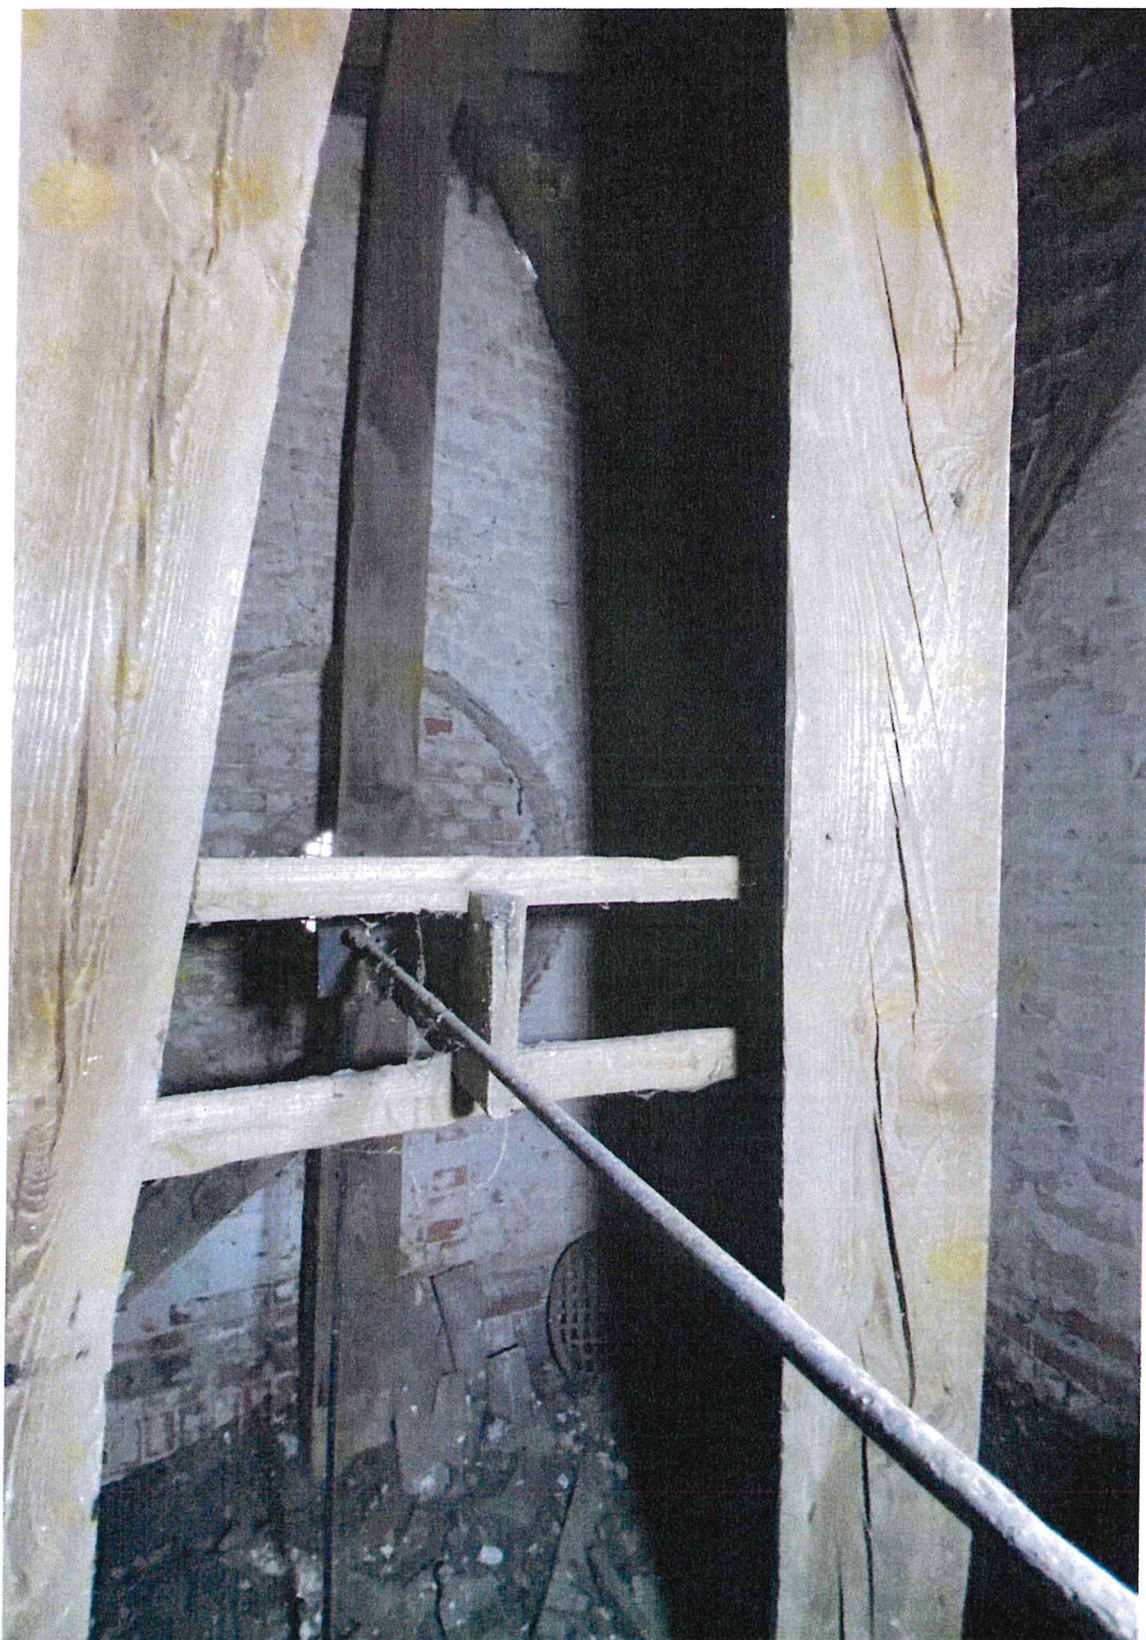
Kościół w Solcu – konstrukcja wieży, źródło: własne (sierpień 2023)
